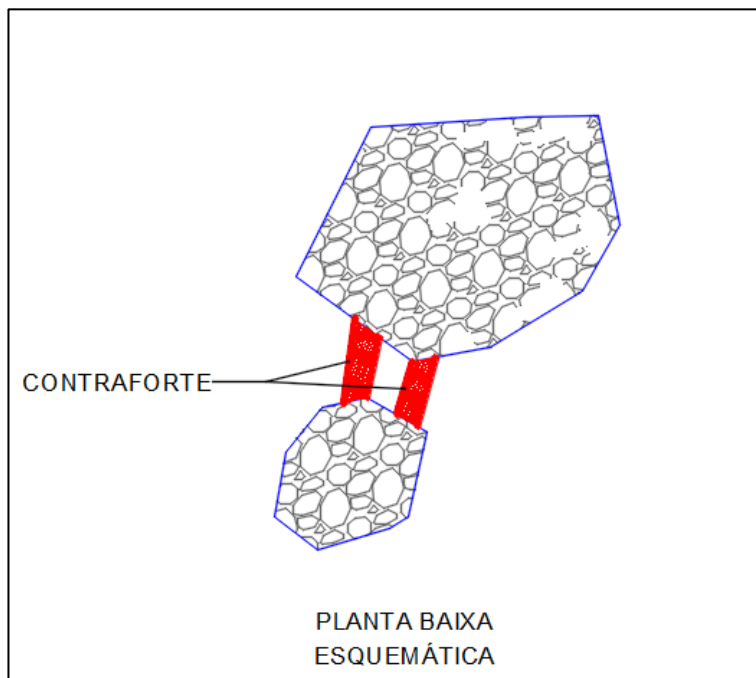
Planta baixa esquemática com implantação dos contrafortes na rocha 03.
